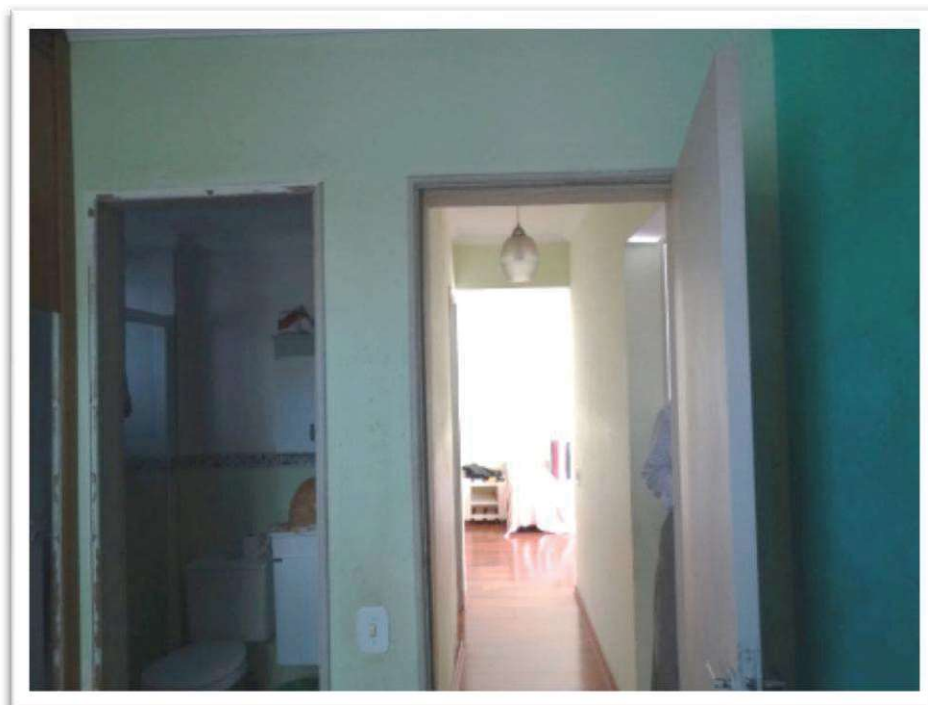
Vista da porta de entrada da suíte do apartamento nº 13 do Edifício Parpan.
